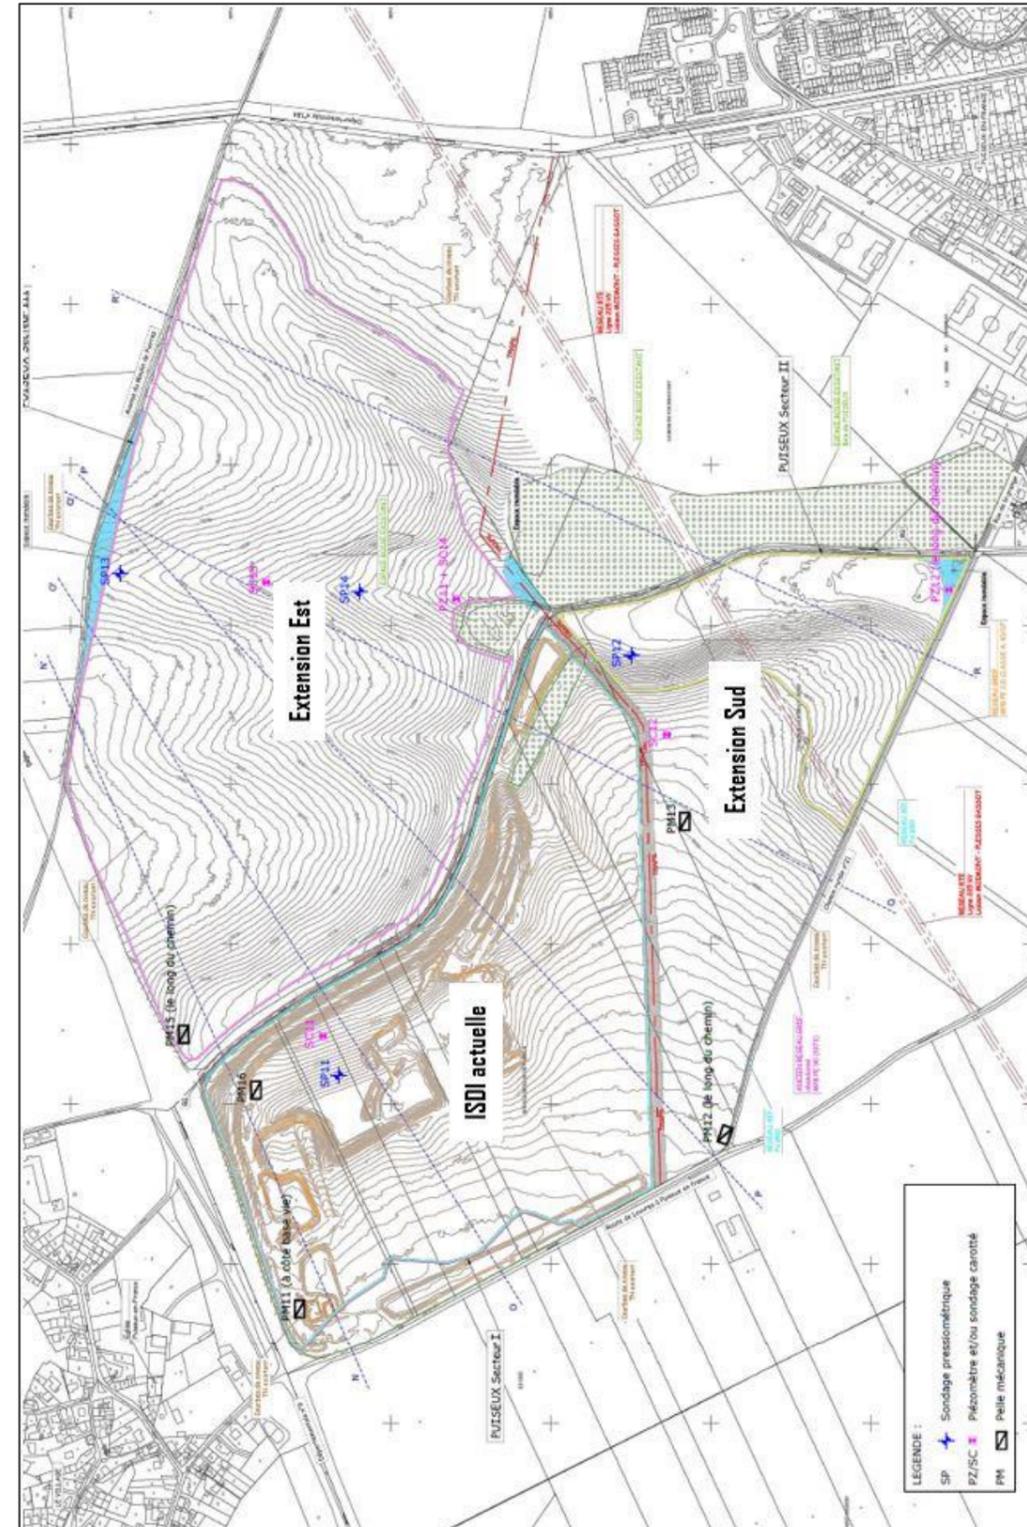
Plan d'implantation des sondages (source : COSSON)
